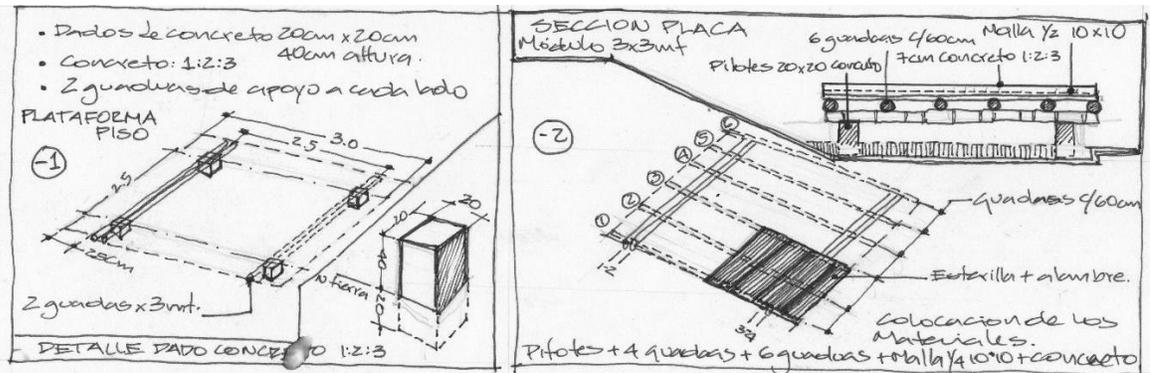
Planteamiento estructural de dados de concreto y módulo inicial de losa de 3 m x 3 m Fuente: Autor.
